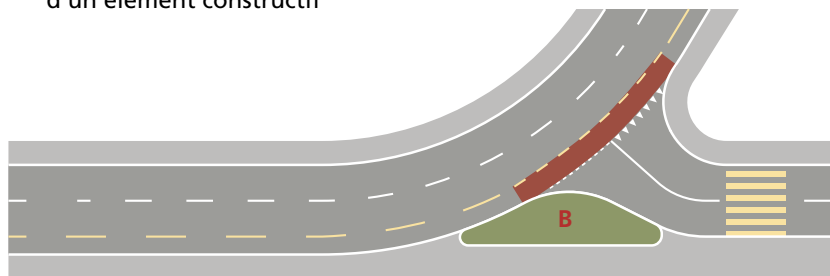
Déflexion à l'aide de l'îlot de protection B sans passage pour les vélos (solution minimale en cas d'espace restreint)
